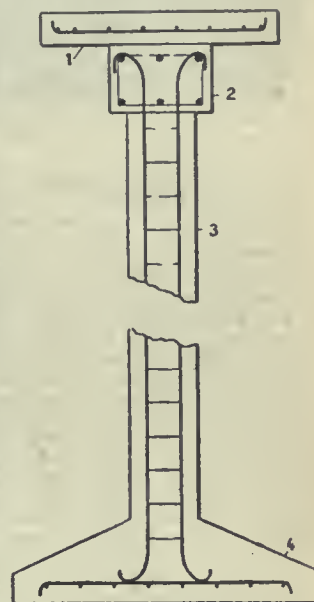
Disposition des armatures dans: 1, une dalle; 2, une poutre; 3, un poteau; 4, une semelle.
